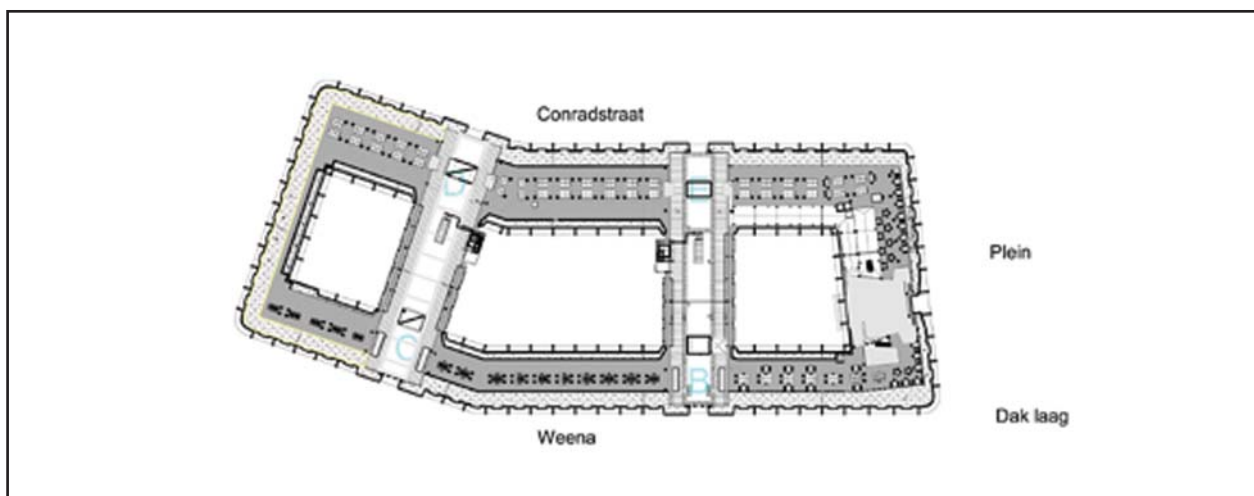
Plattegrond dak Groothandelsgebouw - Architectenbureau J. van Stigt, Rotterdam (www.burovanstigt.nl)
